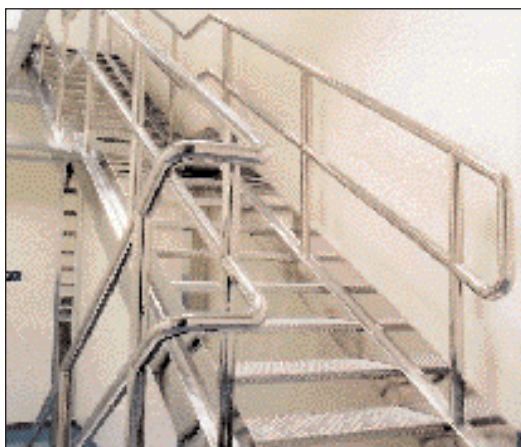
Scala interna fissa con parapetto tubolare 60X2 in AISI 304 utilizzata nell'industria farmaceutica.
